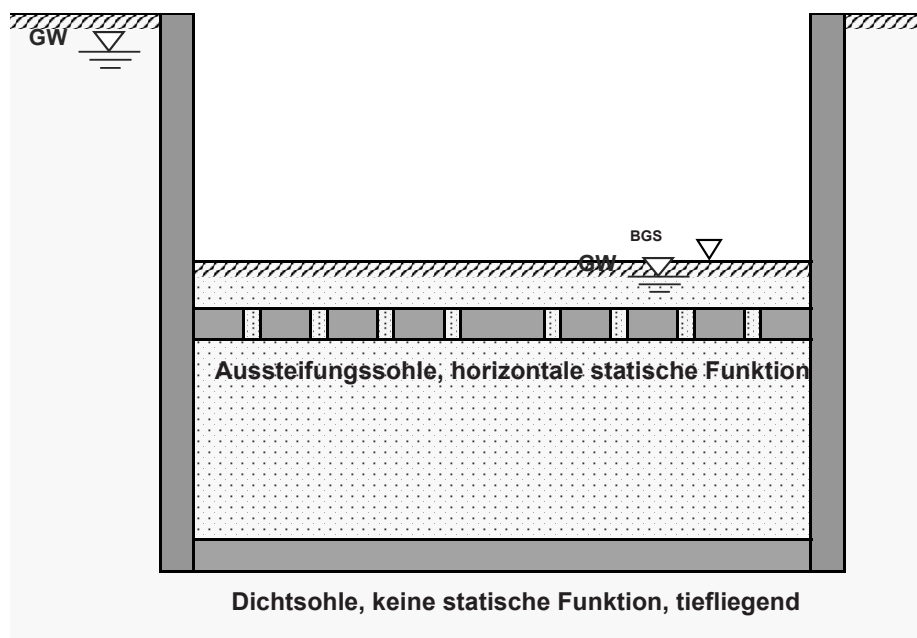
Ausführung einer horizontalen Aussteifungssohle mit Öffnungen für den Grundwasserdurchtritt und einer tieflegenden Dichtsohle
